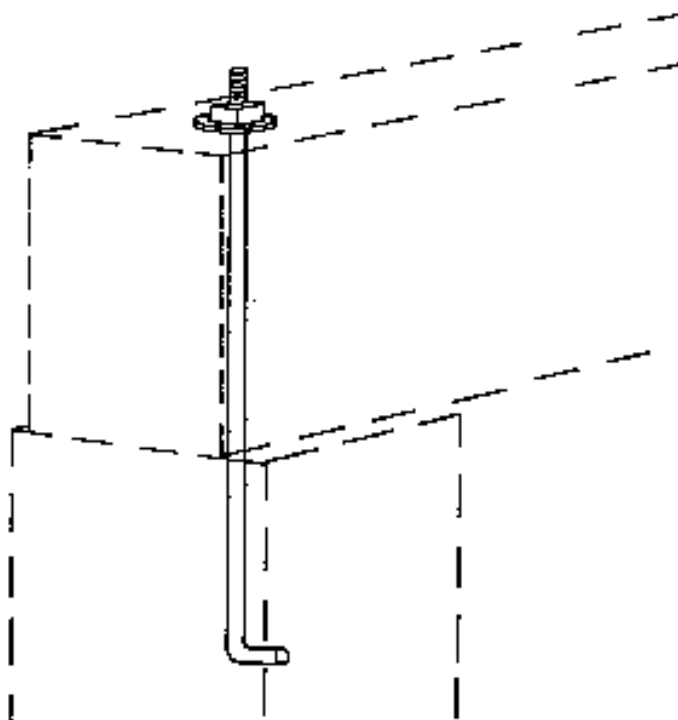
Exemplo simplificado da ligação entre o módulo de piso e a fundação de concreto
